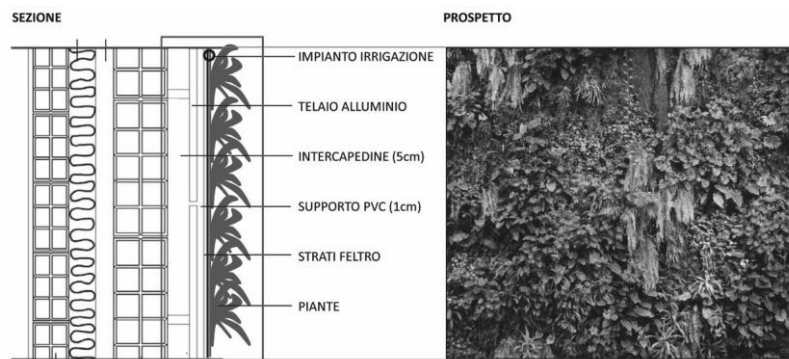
Elementi e struttura del Sistema di Giardino Verticale
